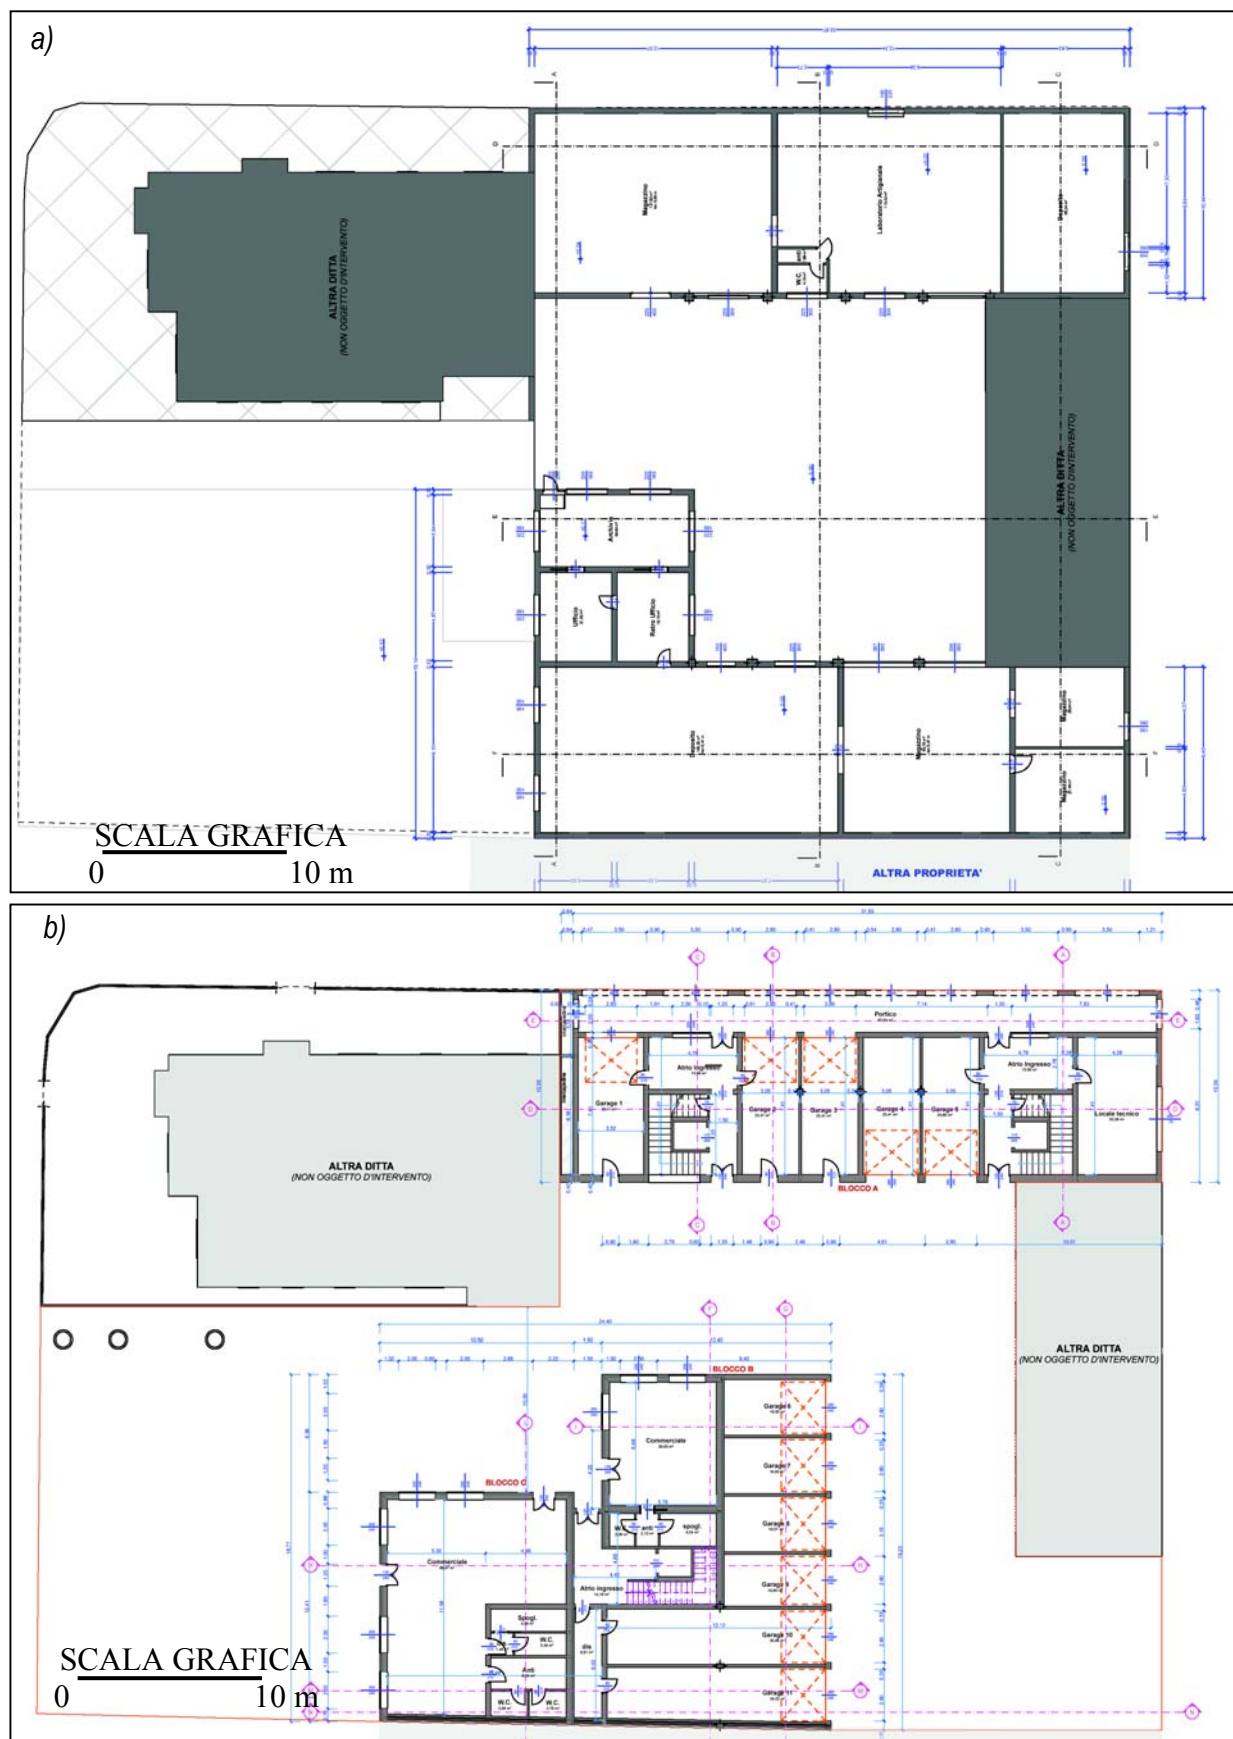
Planimetria del piano terra dello Stato di Fatto (a) e dello Stato di Progetto (b)
